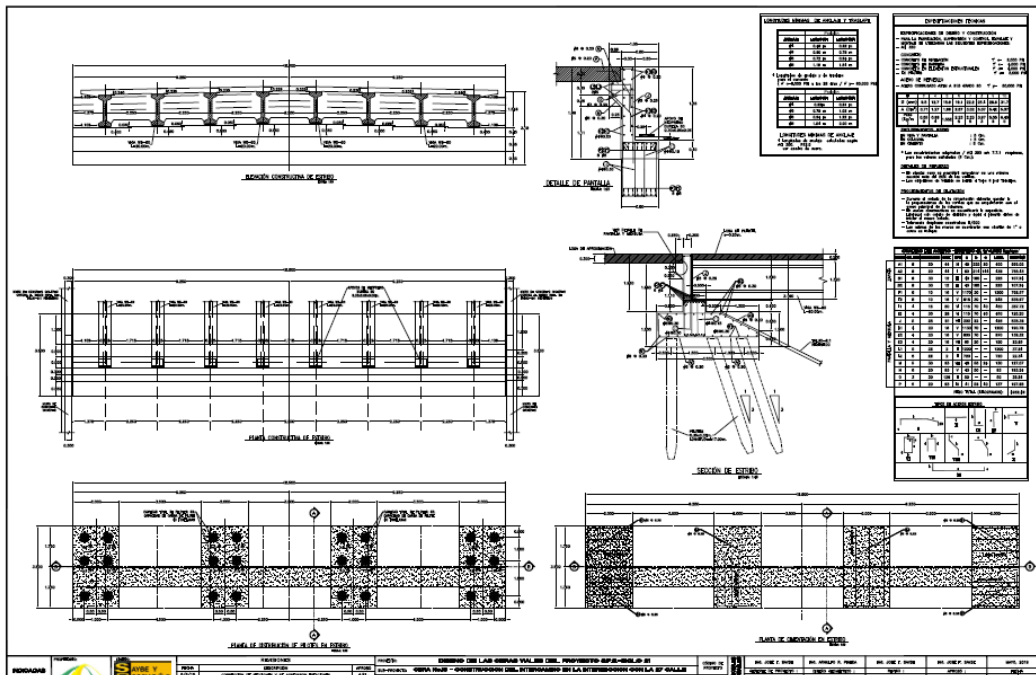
Plano Estructural EST-11, Detalles de Estribo.
